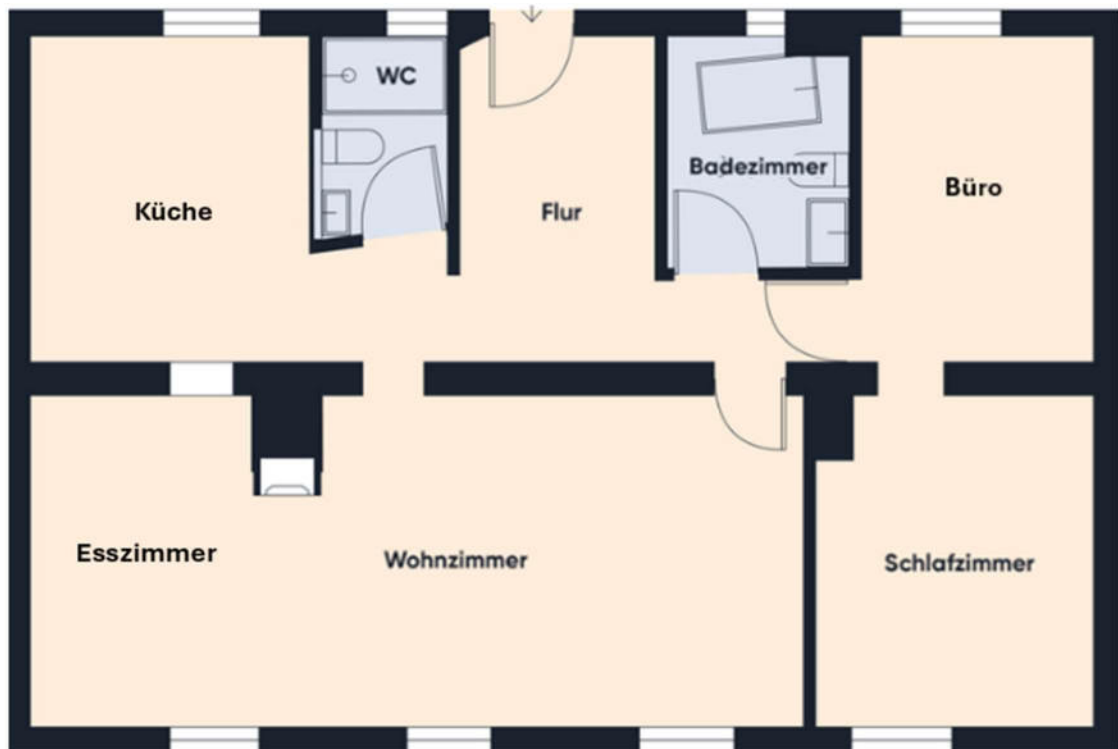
Grundriss Obergeschoss (Aufmaß am Ortstermin)
